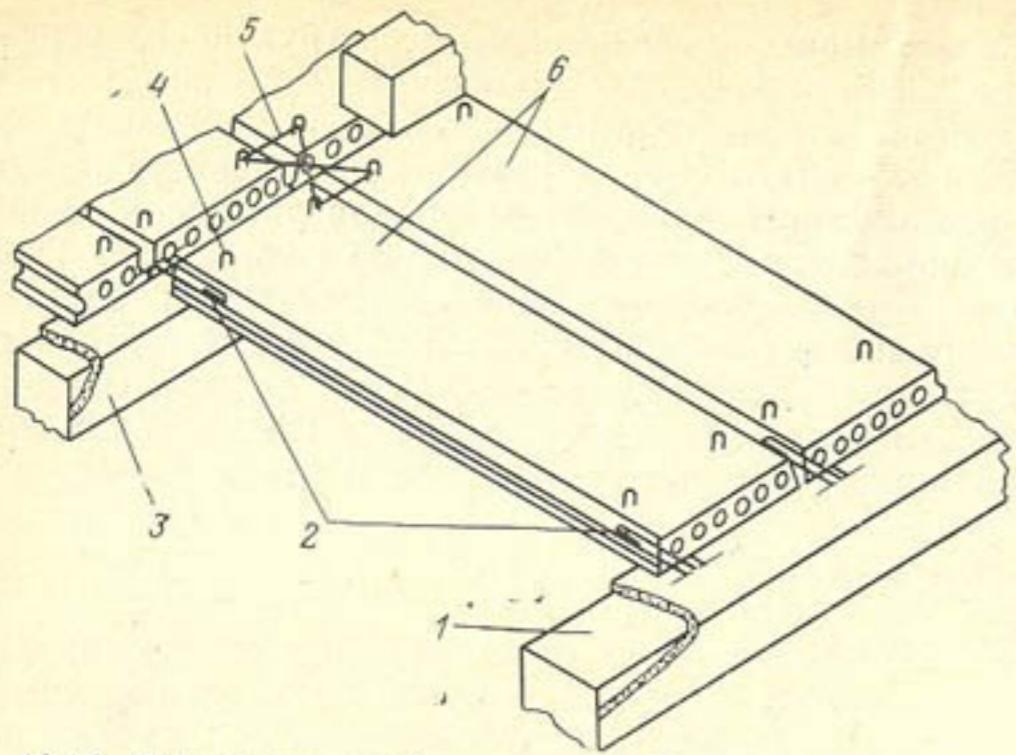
Перекрытие из сборных железобетонных плит:
